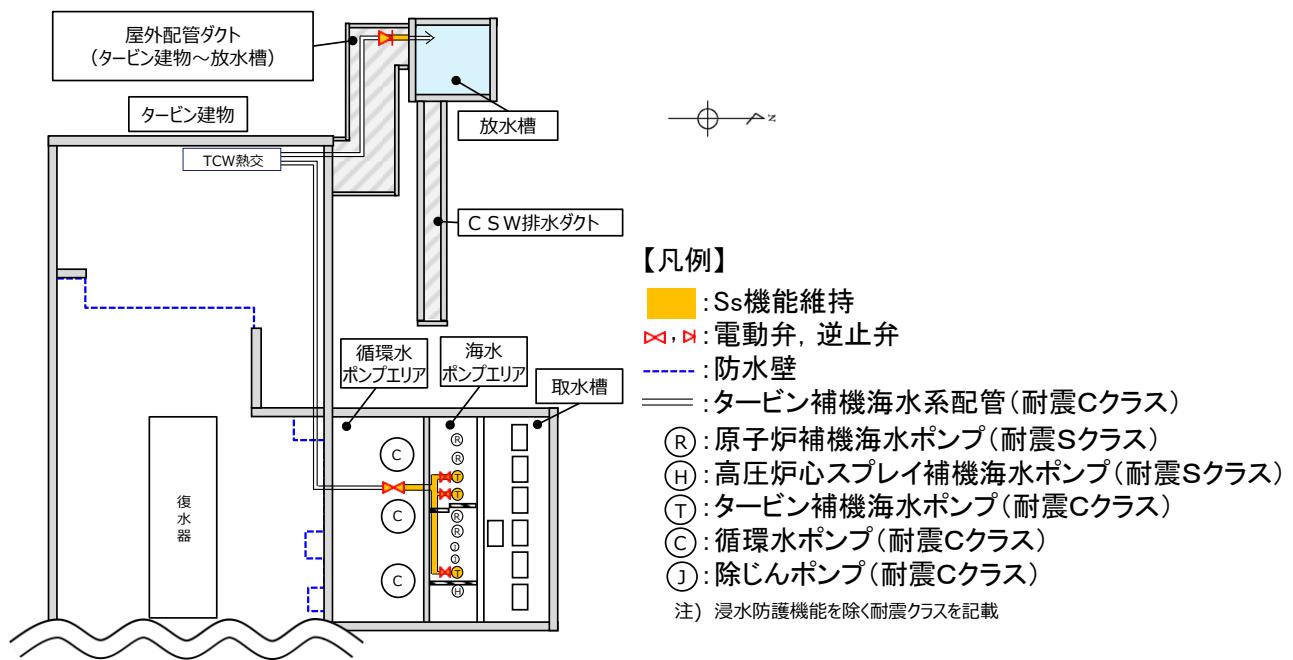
タービン補機海水系の対策概要 (平面図)
